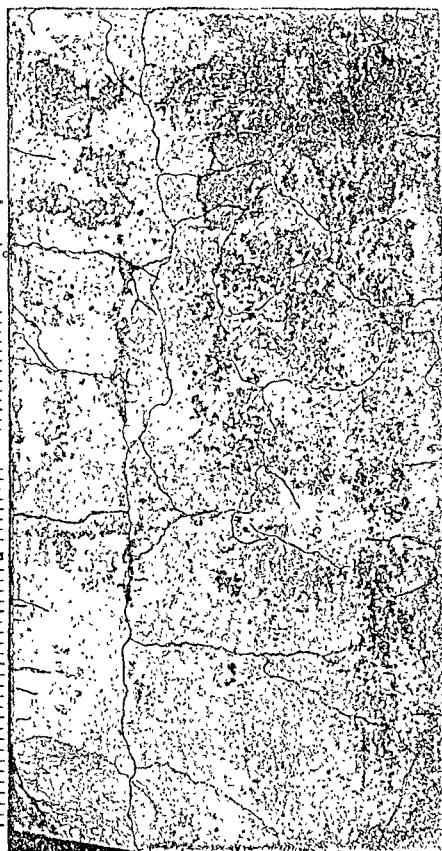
鉄筋コンクリートモデルのひびわれ
